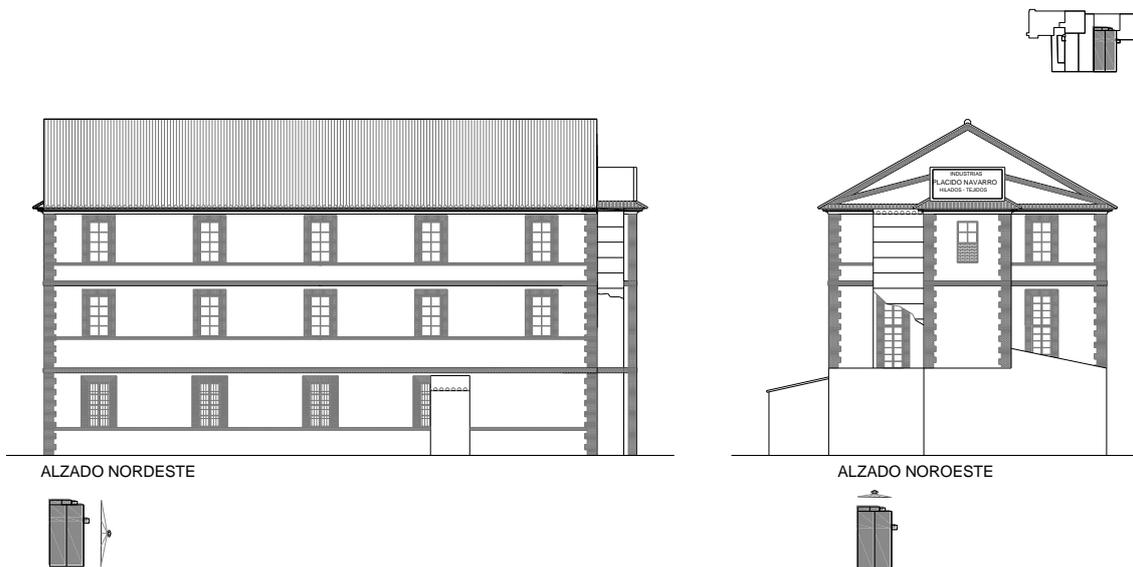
Planos de alzado del conjunto edificado del molino (elaboración propia)
